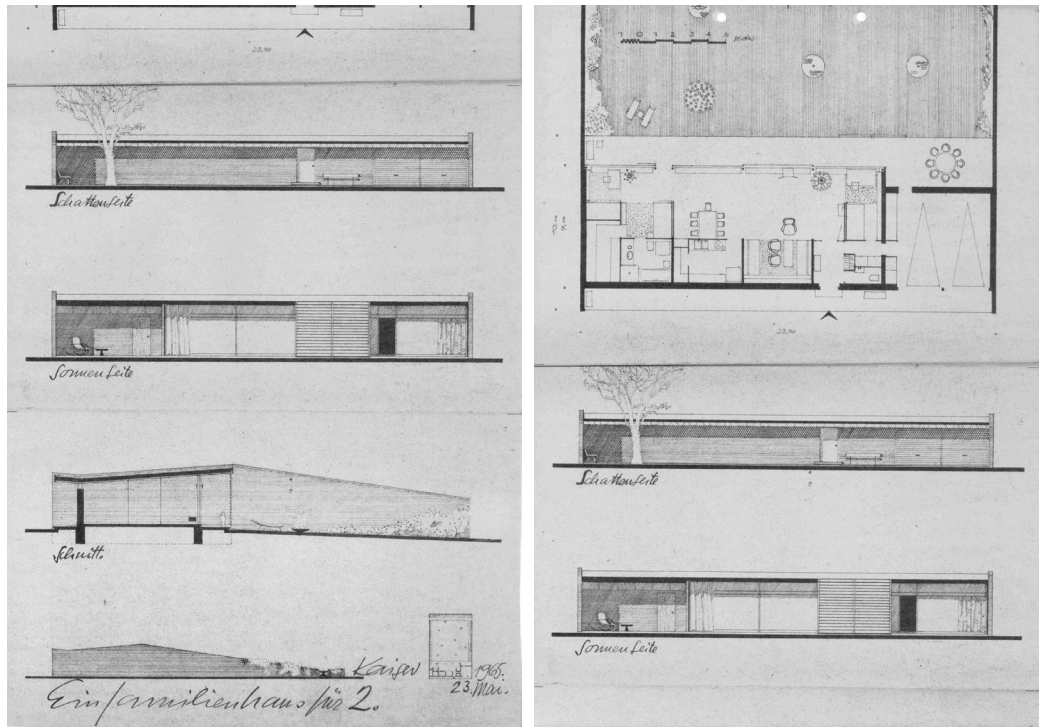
Josef Kaiser, Glas-Backstein-Haus, Grundriss und perspektivische Ansichten, 23.5.65.
